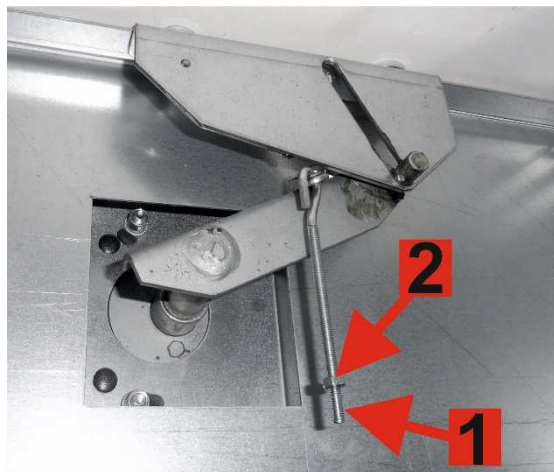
Klapa p.poż. – widok z zewnątrz
